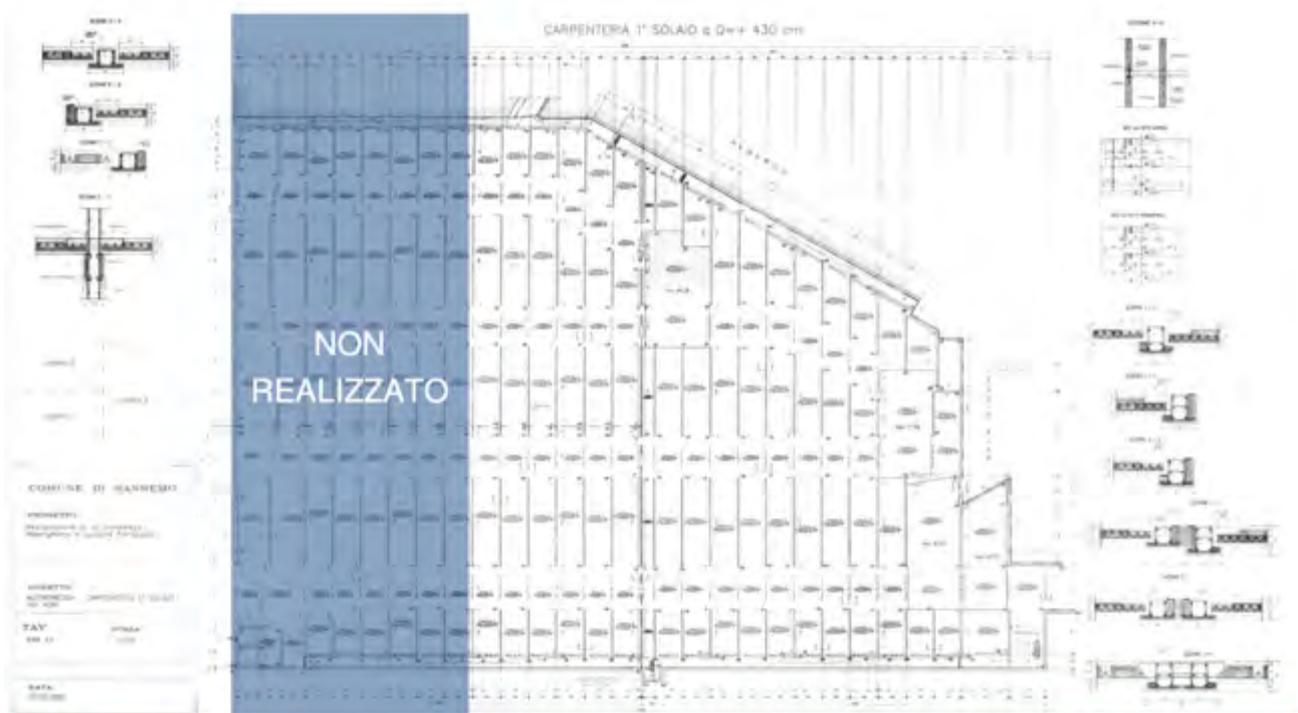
Carpenteria primo solaio (Progetto originale delle strutture oggetto di demolizione).
